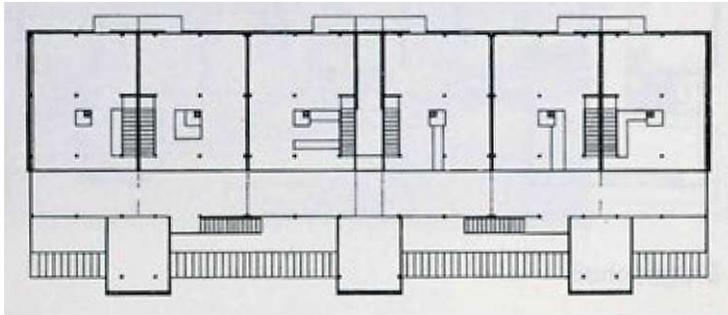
Siedlung Nachtgärtele | Grundriss OG | Arch.: Wolfgang Juen
